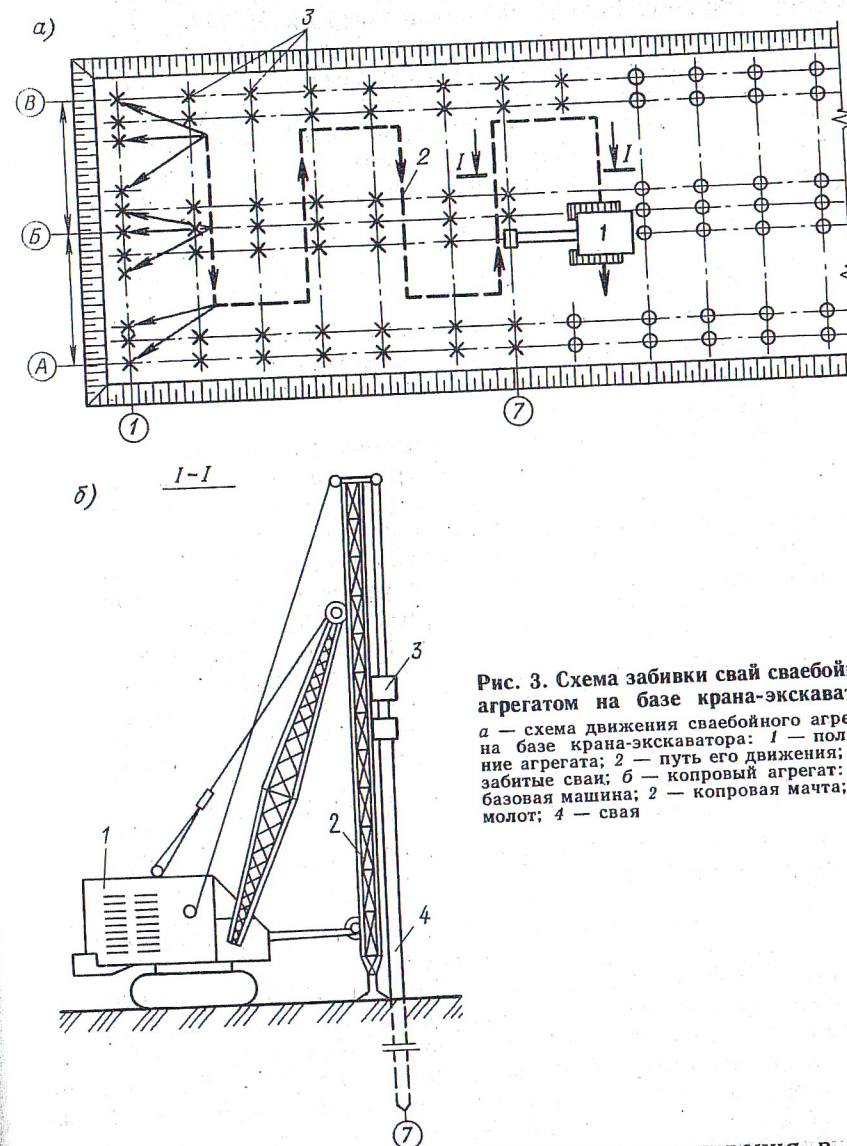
Схема забивки свай сваебойным агрегатом на базе крана-экскаватора
